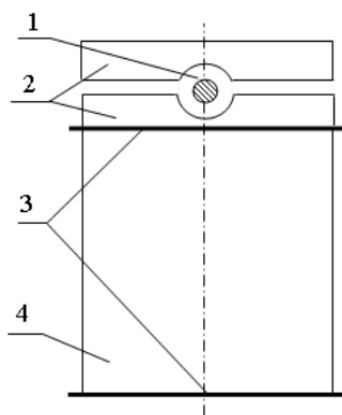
Схема шарнірного пристрою, встановленого на торець зразка:
